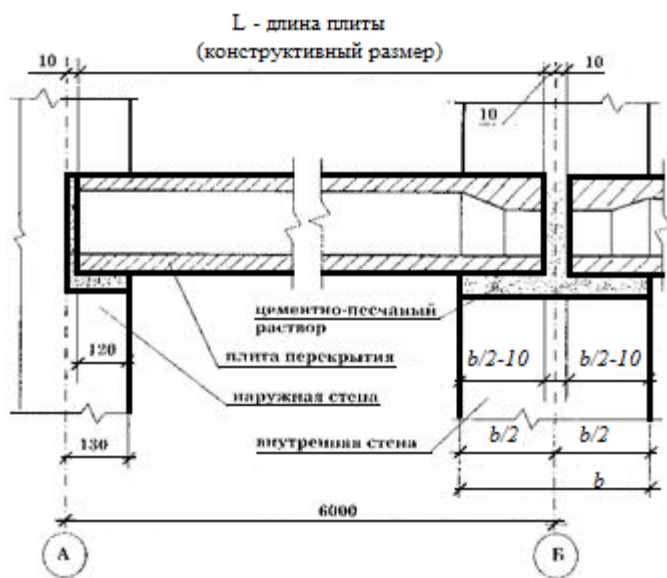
Привязка плит перекрытий к координационным осям несущих наружных и внутренних стен здания.
